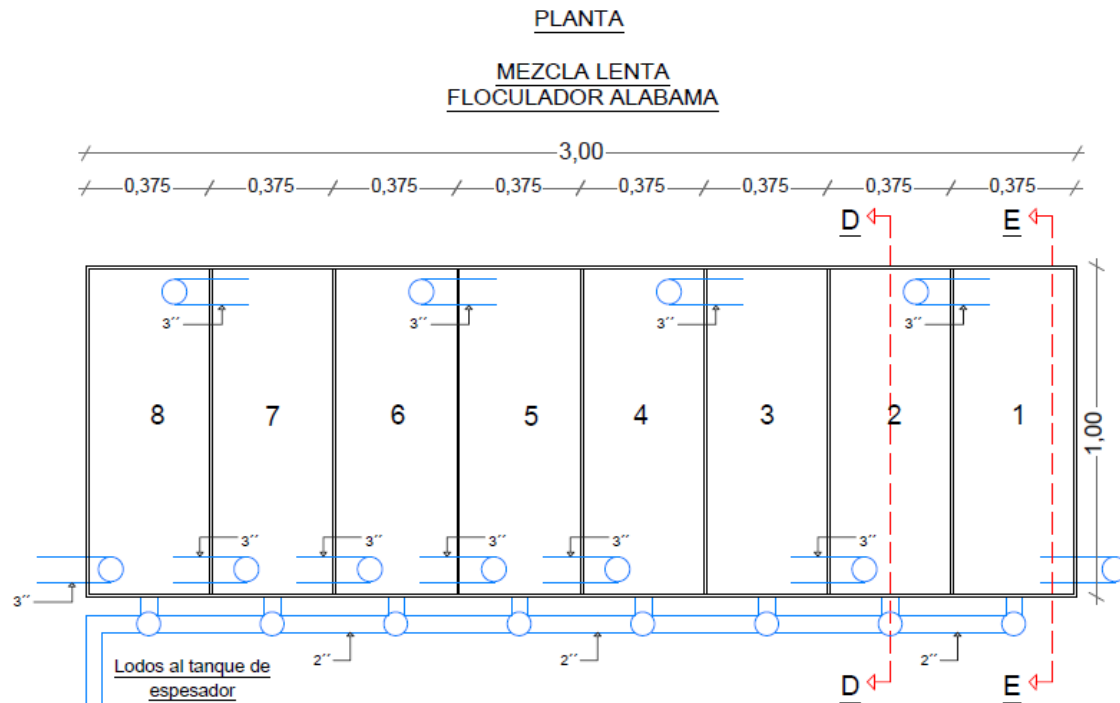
Vista superior de planta del floculador Alabama propuesto para el tratamiento
